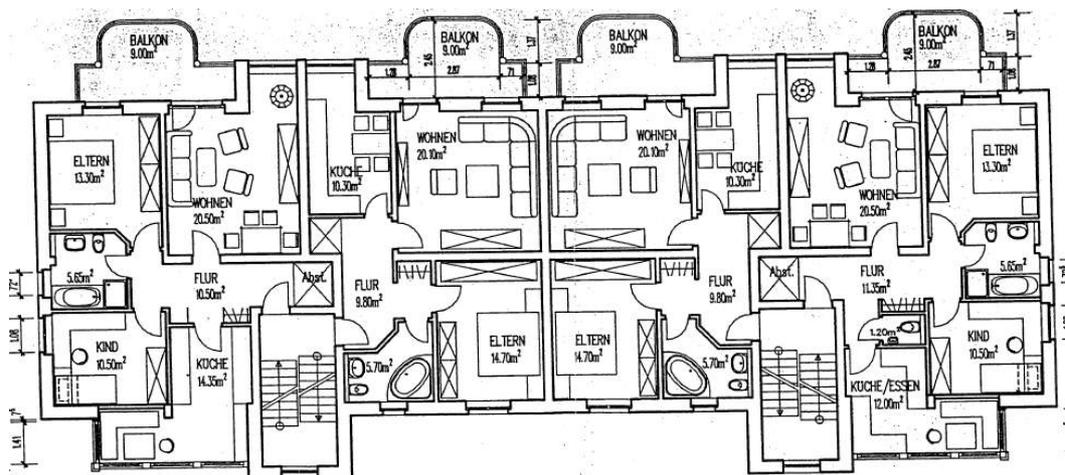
Grundriss OG, Planausschnitt o.M.
